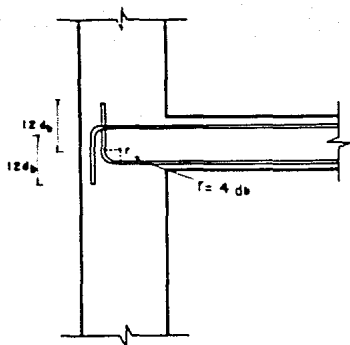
Detalle de anclaje del refuerzo de una viga en una columna de borde en zona sísmica.
